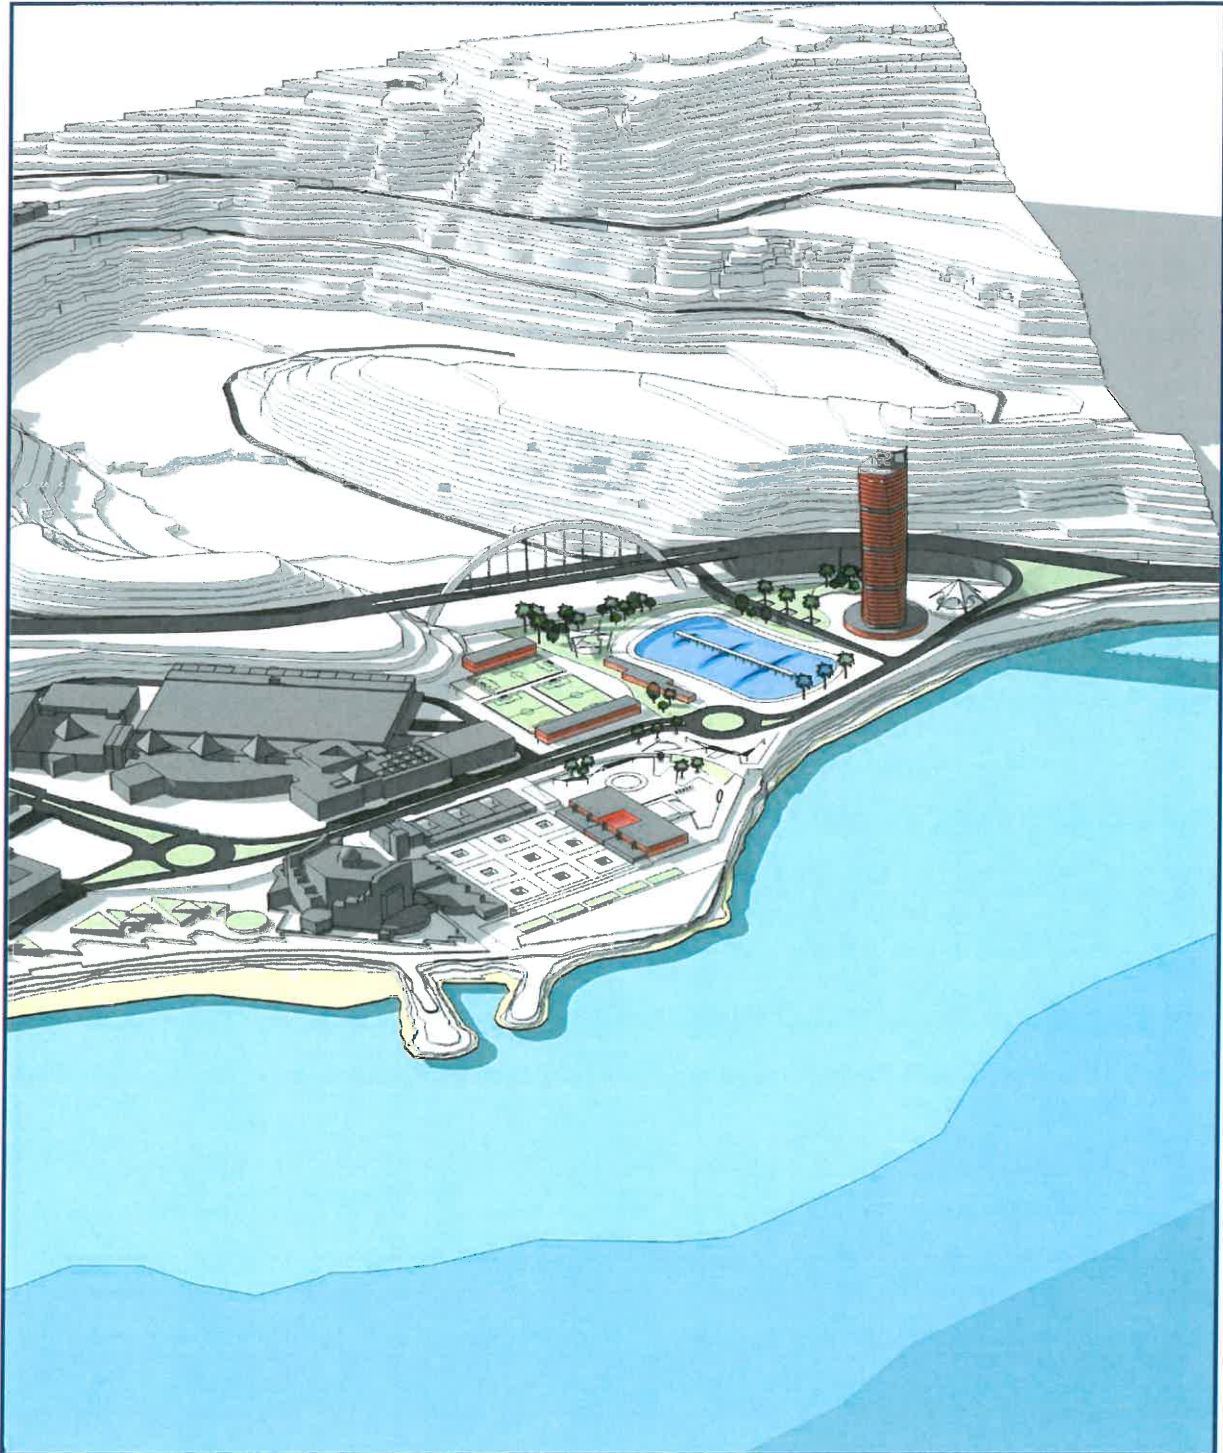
Alternativa 2. Imagen de la volumetría 1. Fuente: elaboración propia
